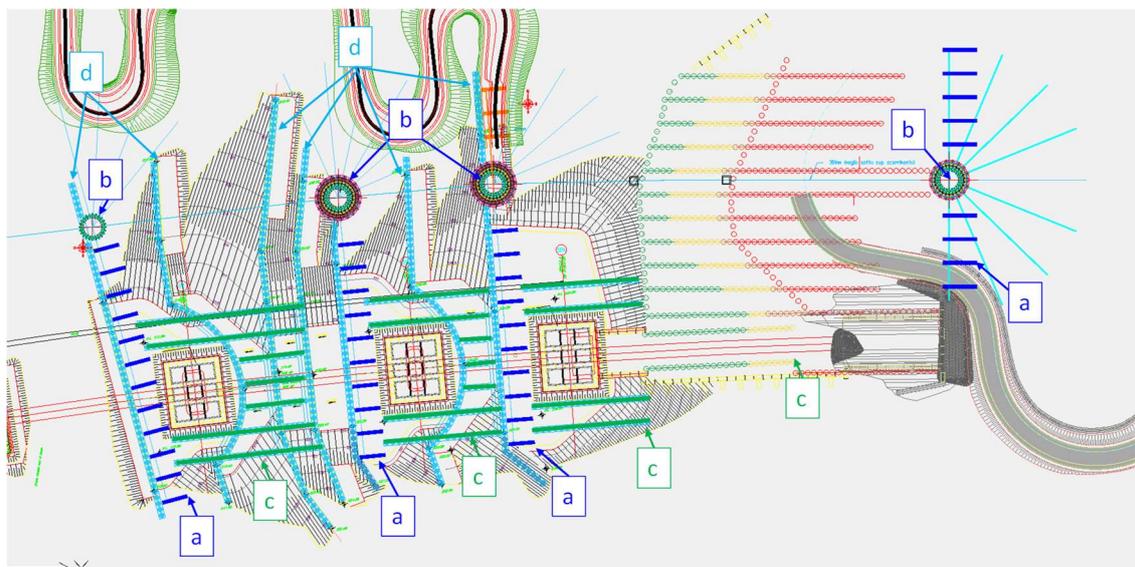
Schema dell'intervento con l'ubicazione delle principali opere di stabilizzazione
